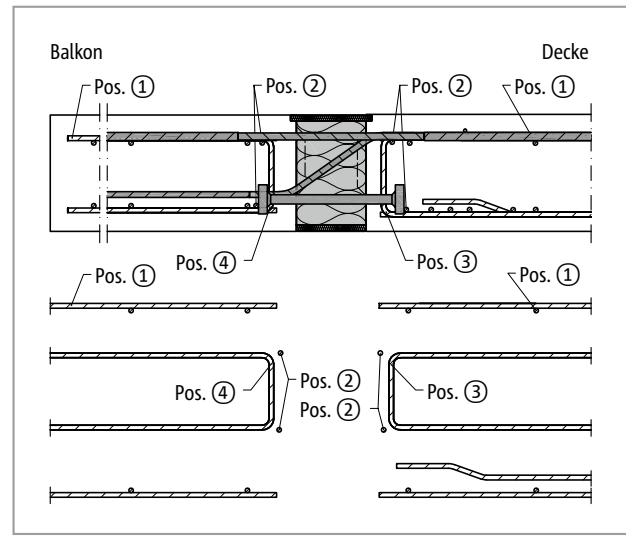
Schöck Isokorb® XT Typ K-M11: Bauseitige Bewehrung bei indirekter Lagerung
